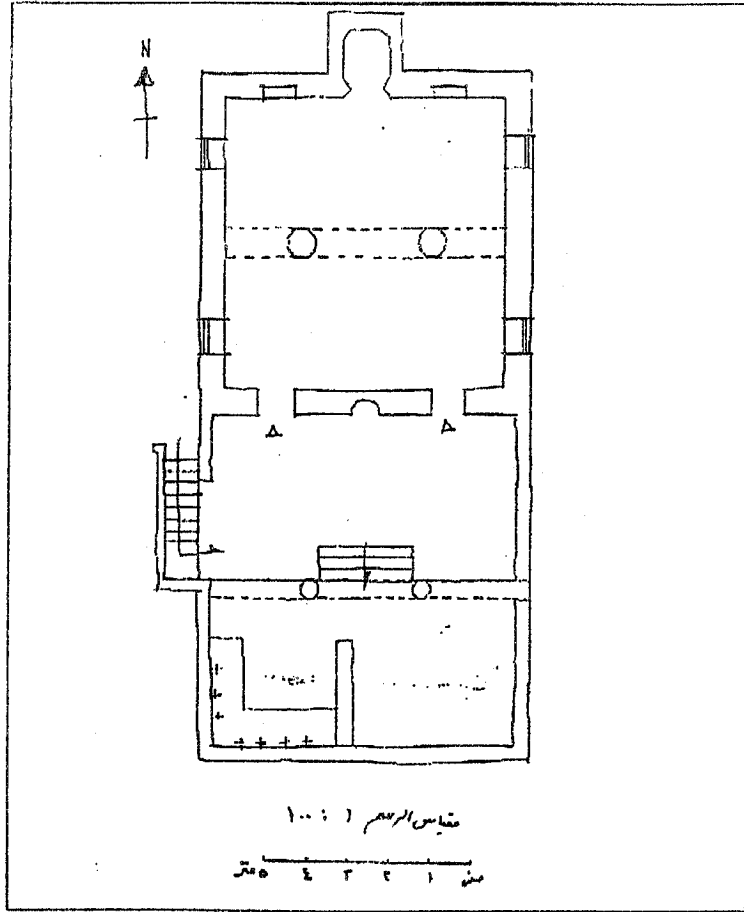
مسقط أفقي لمسجد السيد حمود البوسعيدي بحاليندي (١٢٧٢ هـ / ١٨٥٥ م).
